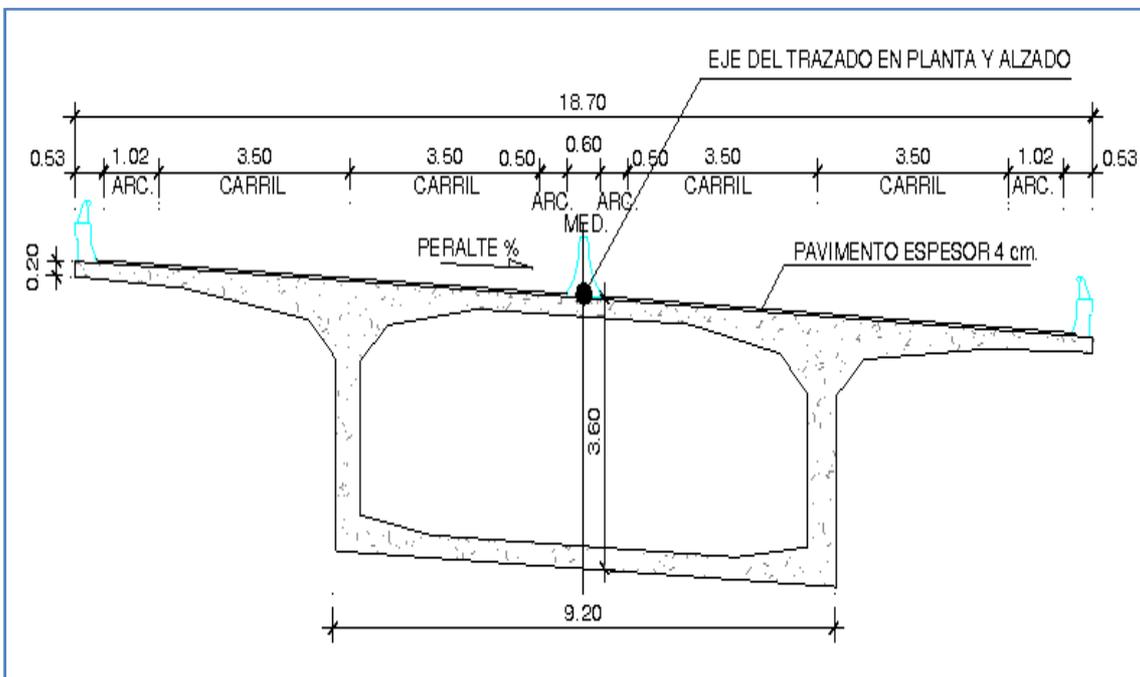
CORTE TRANSVERSAL CENTRO VANO.
